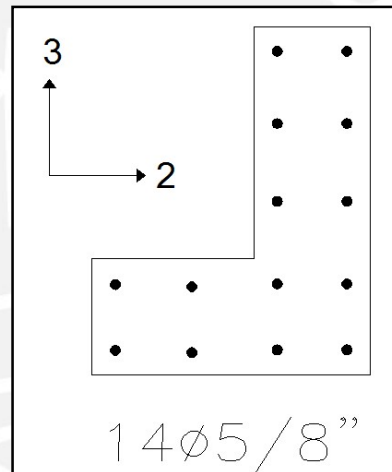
Refuerzo vertical propuesto para la columna C4.
